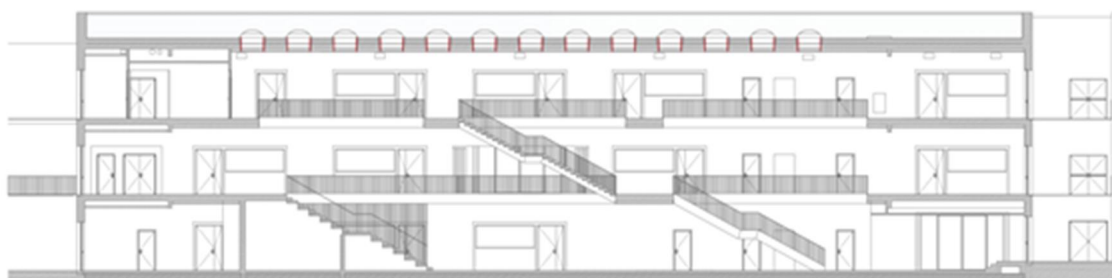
Planimetria della copertura con indicazione del posizionamento del trattamento acustico a lato dei lucernari_sezione
